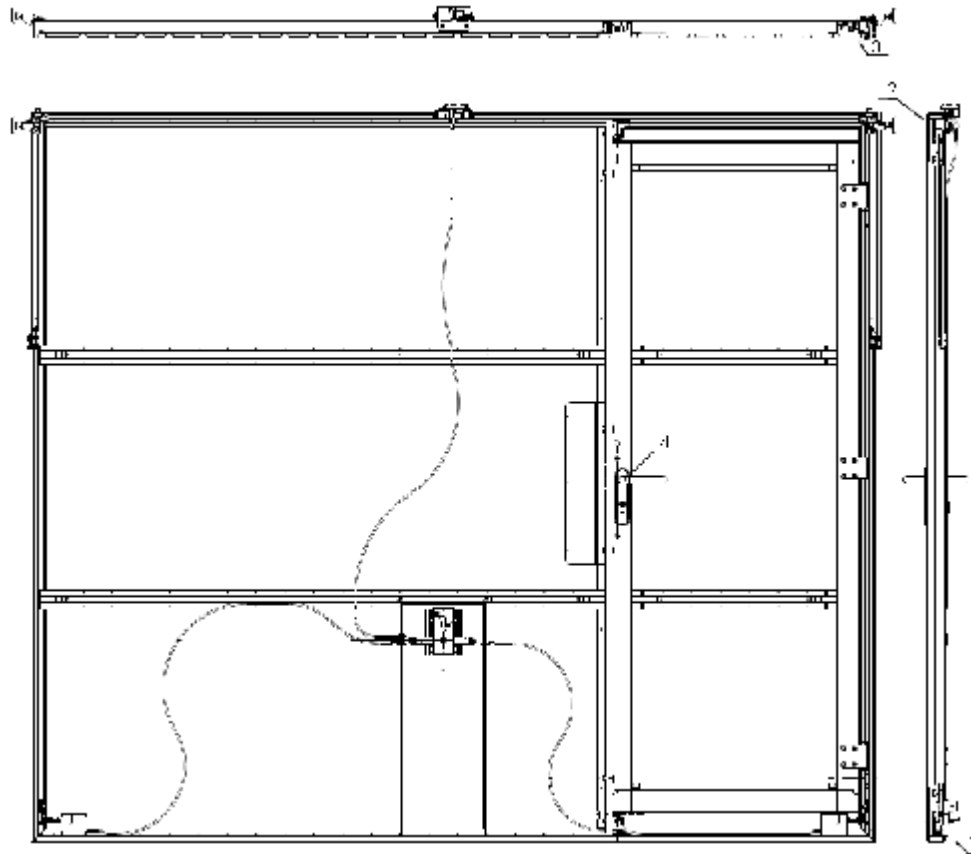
Widok bramy segmentowej garażowej podnoszonej z drzwiami
